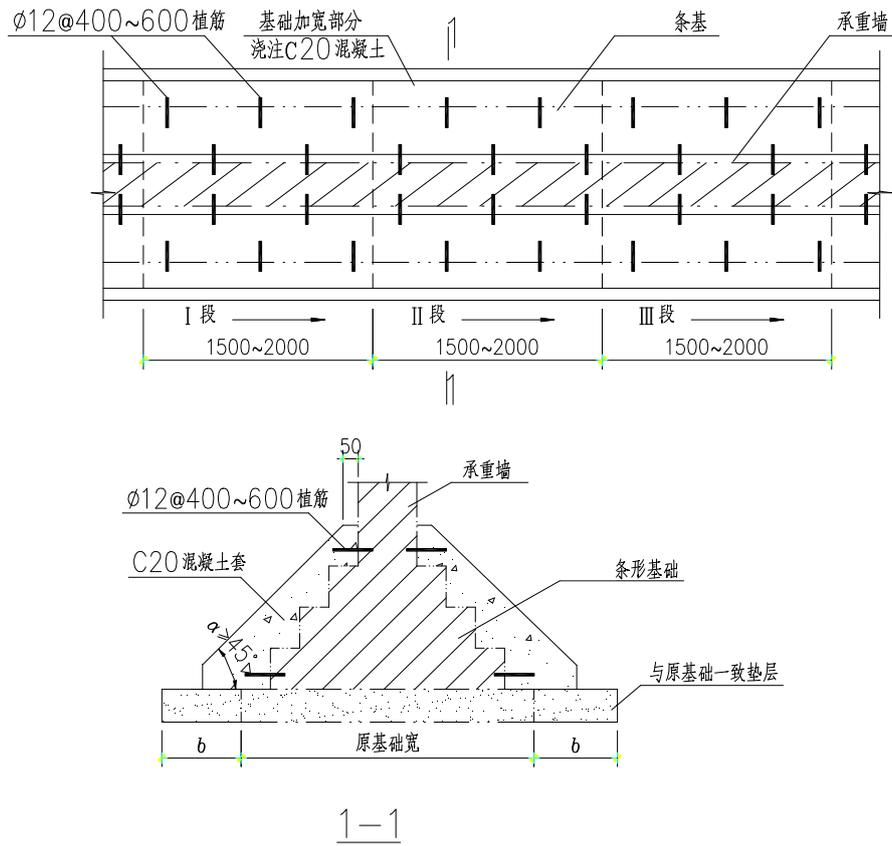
混凝土套加宽无筋扩展基础底面积
